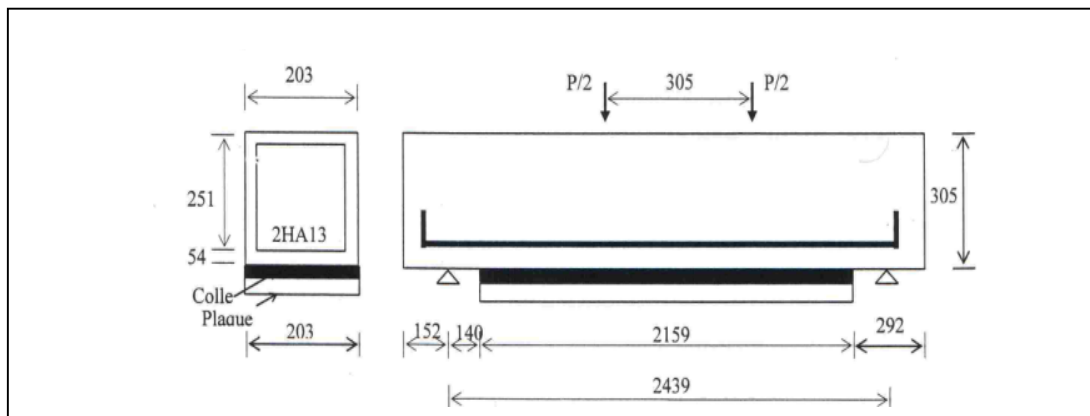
Montage de la poutre renforcée par une plaque de CFRP (S6-PRE3) [102]
